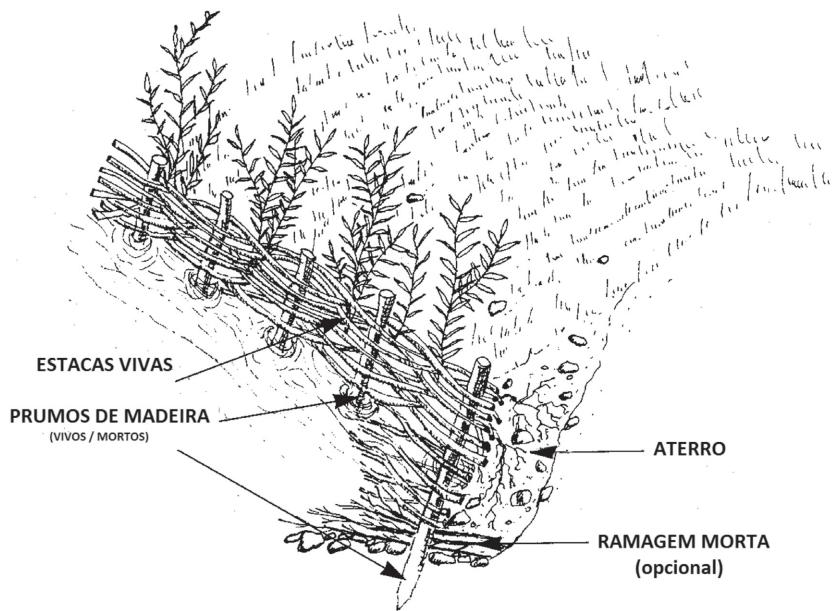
Pormenores de instalação de entrançado vivo adaptado de Venti, D. et al.³³
